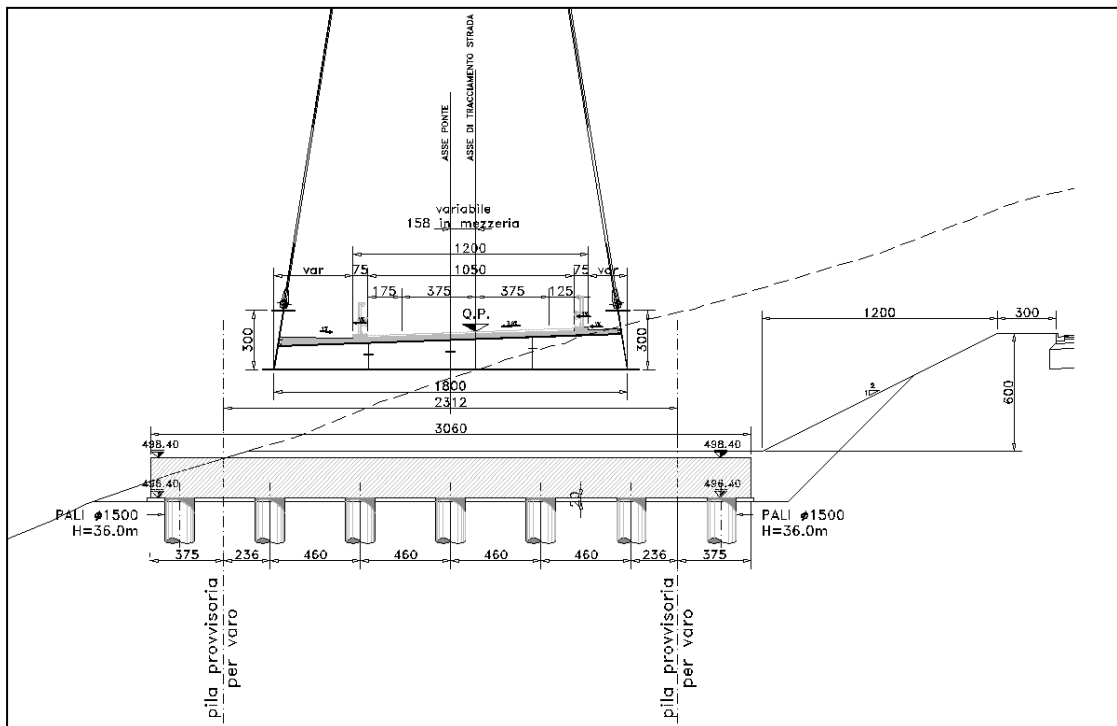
Carreggiata SX – Sezione Trasversale della struttura provvisori
